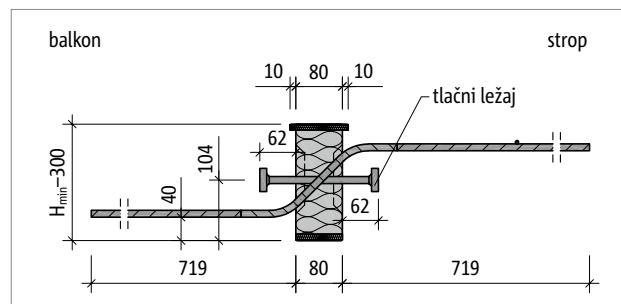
Schöck Isokorb® T tip QP-V4: prerez proizvoda
